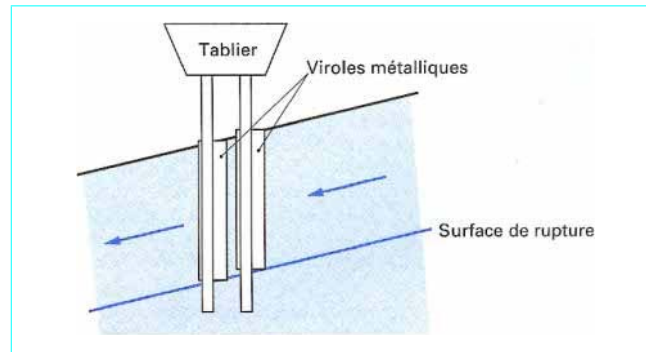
Fondation sur pieux protégés par des viroles métalliques [2]
